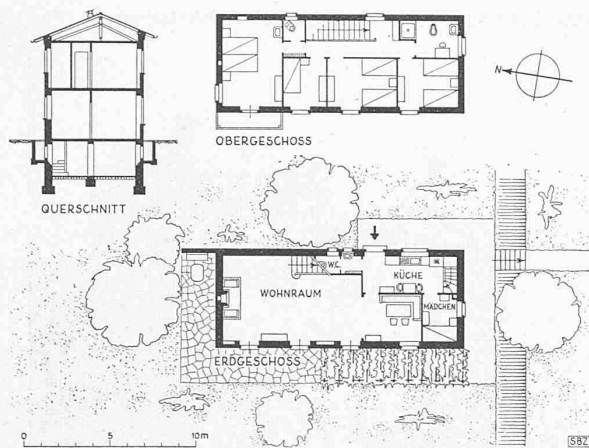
Grundrisse und Schnitt 1:400 des Ferienhauses in Vira-Gambarogno
